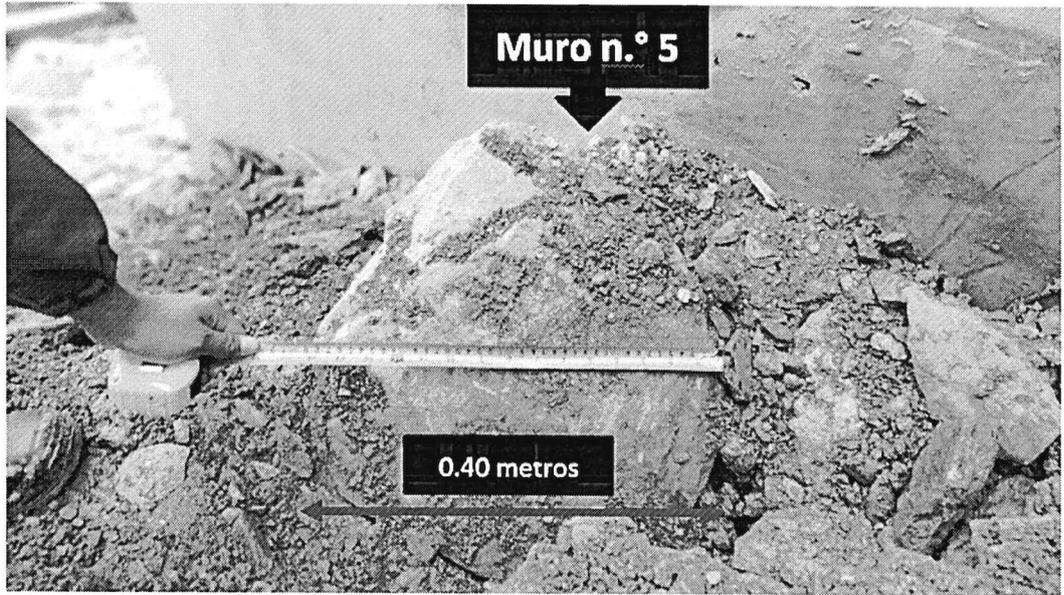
Se evidenció piedra de 0.40 metros de ancho, detrás del muro de concreto armado n.º 5.
